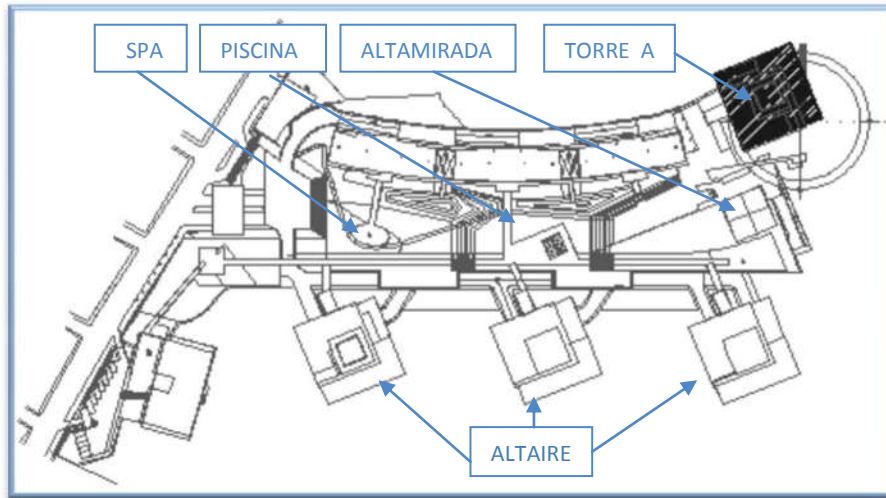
² Planta de conjunto parque residencial vidalta.
